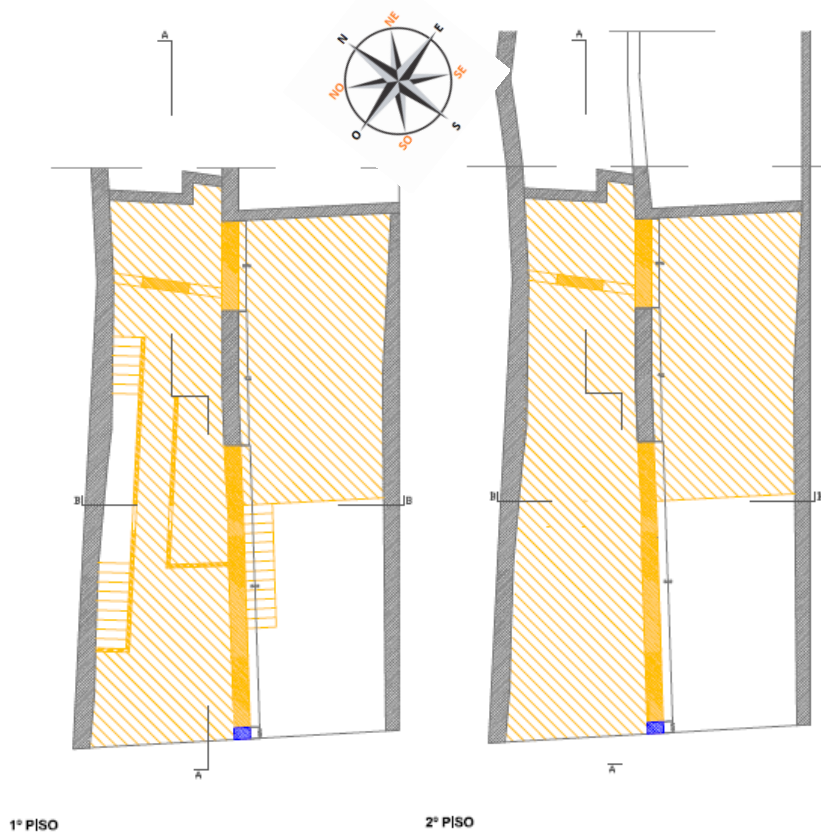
Plantas de demolição do 1º e 2º piso [14]
